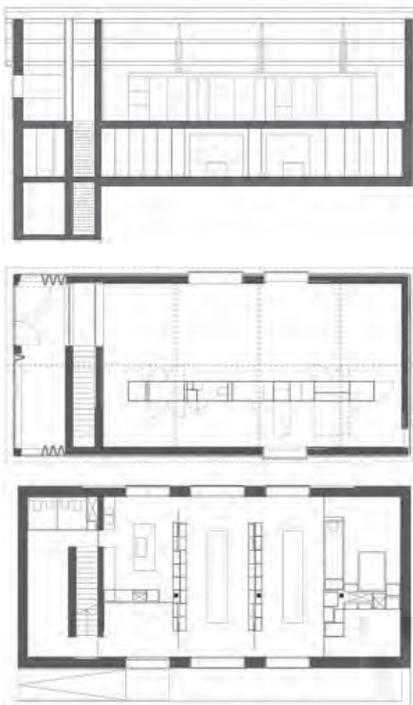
, Längsschnitt, Grundriss Ebene +1, Grundriss Ebene 0 (v.o.n.u.)
